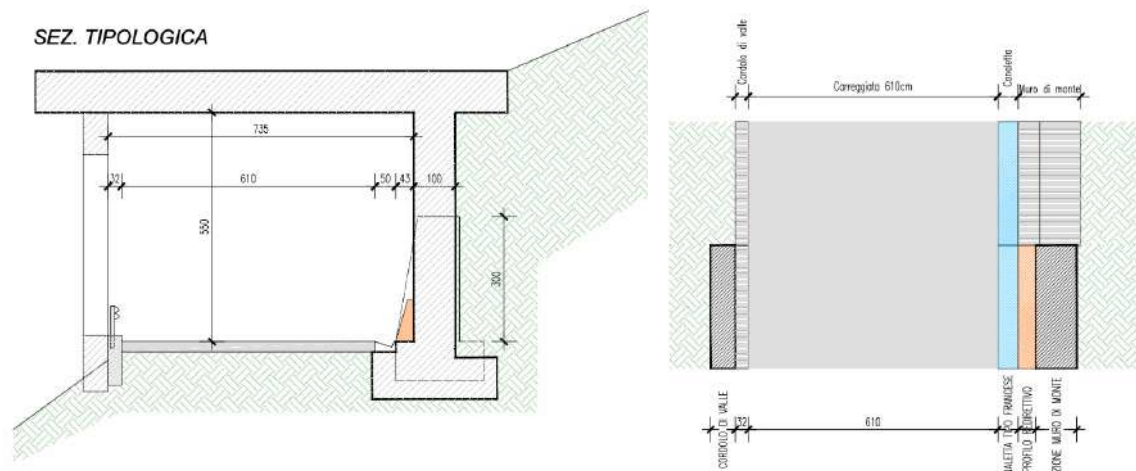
Sezione tipo e dettaglio planimetrico della galleria in progetto
